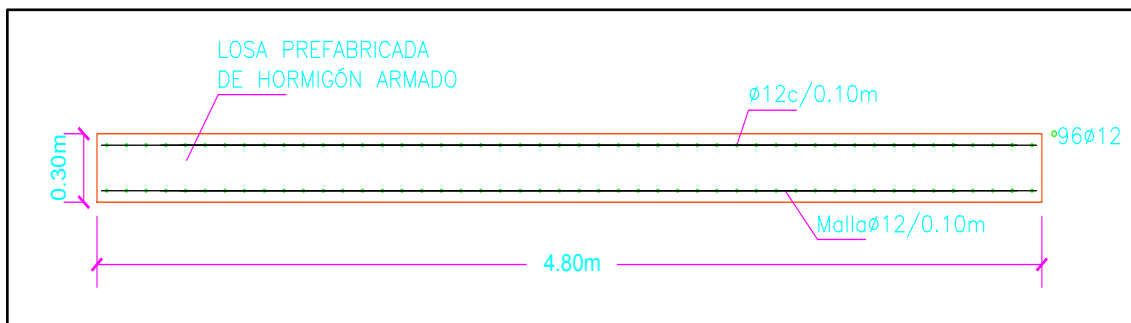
Dimensionamiento de la losa para el muelle principal. Fuente: Autores
